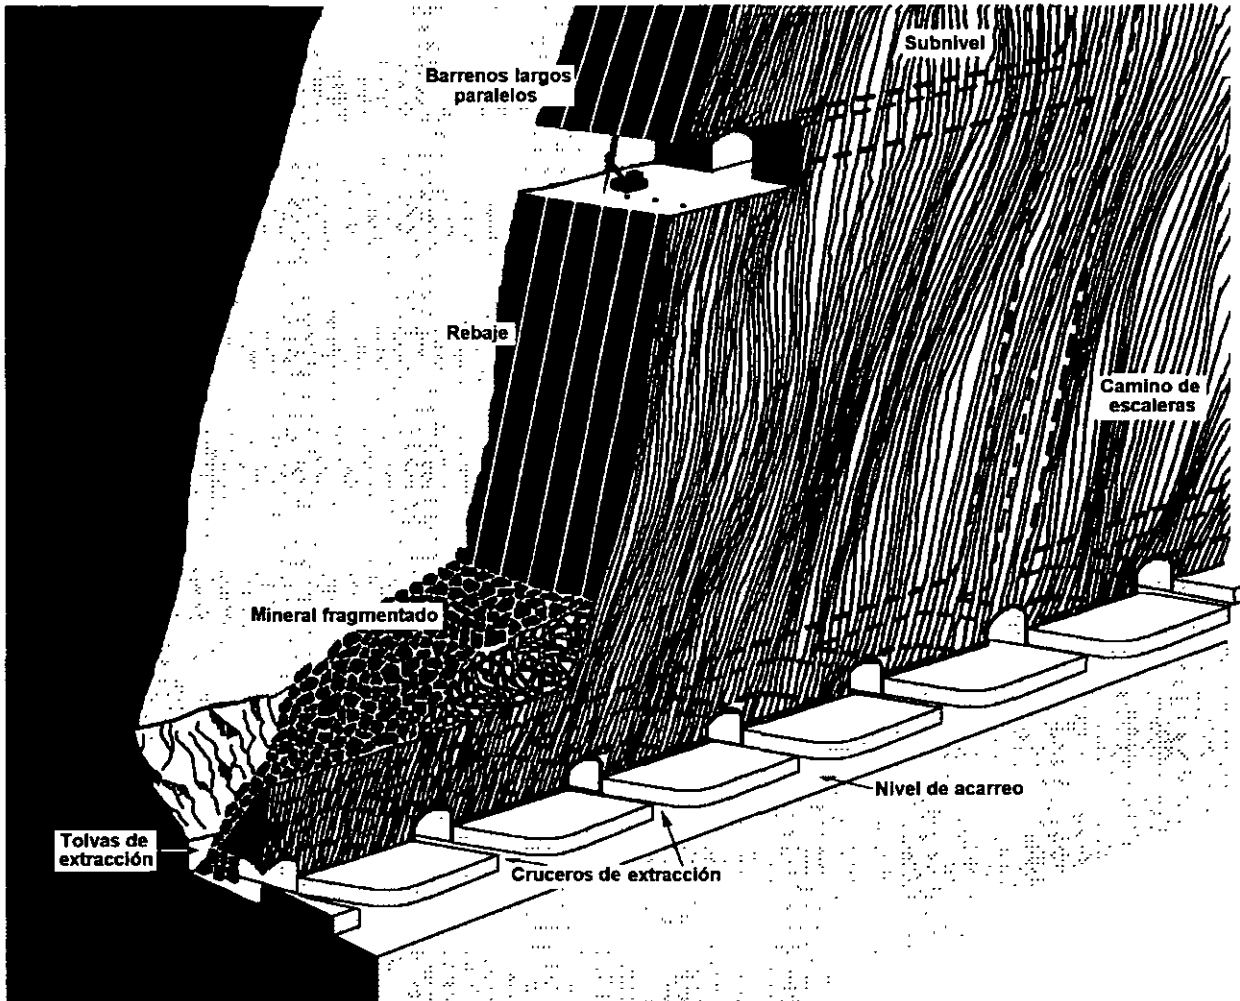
TUMBE POR SUBNIVELES EN REBAJES LONGITUDINALES USANDO BARRENACIÓN LARGA EN VETAS ANCHAS
